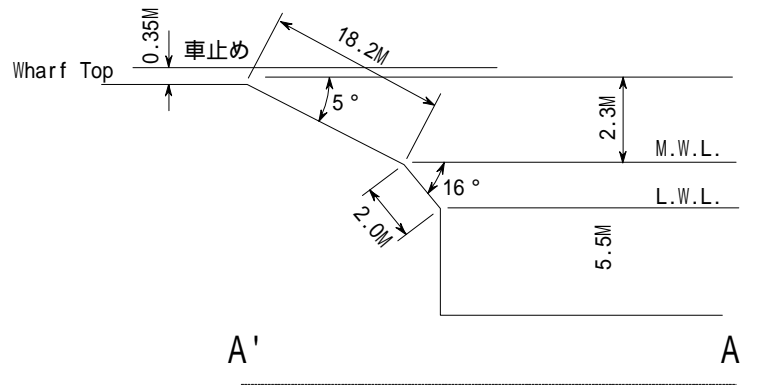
オロバハ号用埠頭断面図 (A-A'断面)
